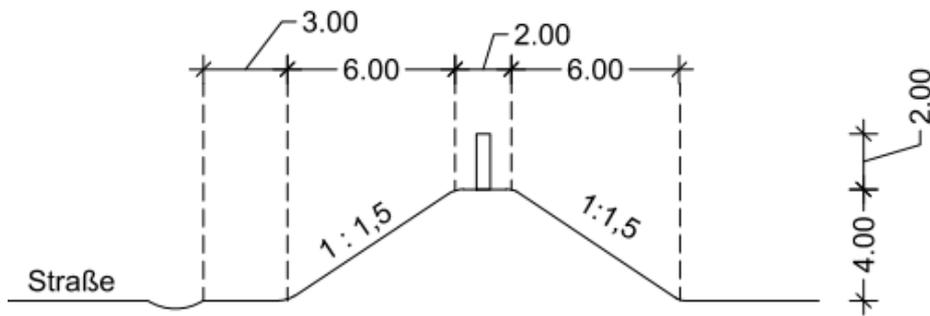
Systemschnitt durch den Lärmschutzwall (unverbindlich)
